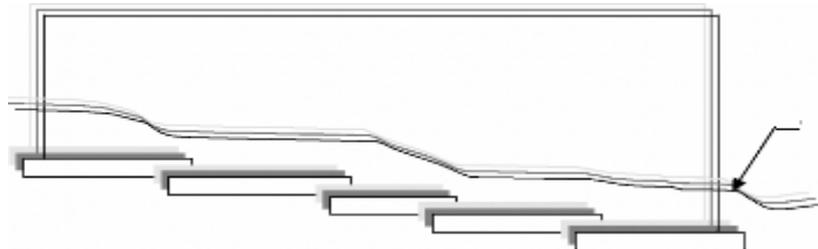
Semelles décalées sur site en pente (principe schématique). (Source ANCO)
